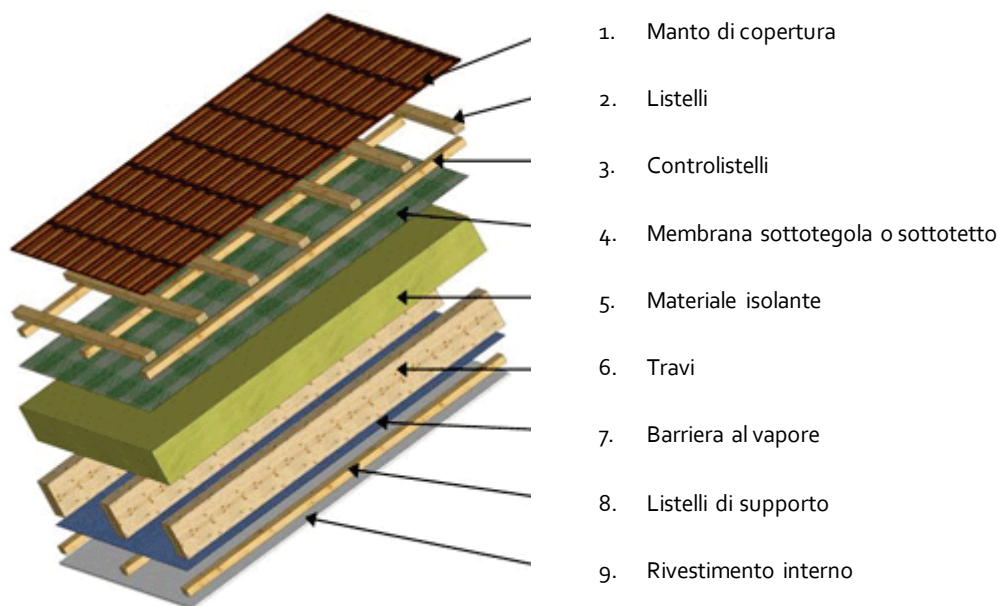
Esempio di una struttura di copertura con isolamento sopra le travi (fonte: [www.Holzfragen.de](http://www.Holzfragen.de), Sachverständigenbüro für Holzschutz Hans-Joachim Rüpke / Dr. Ernst Kürsten Hannover, adattato)
